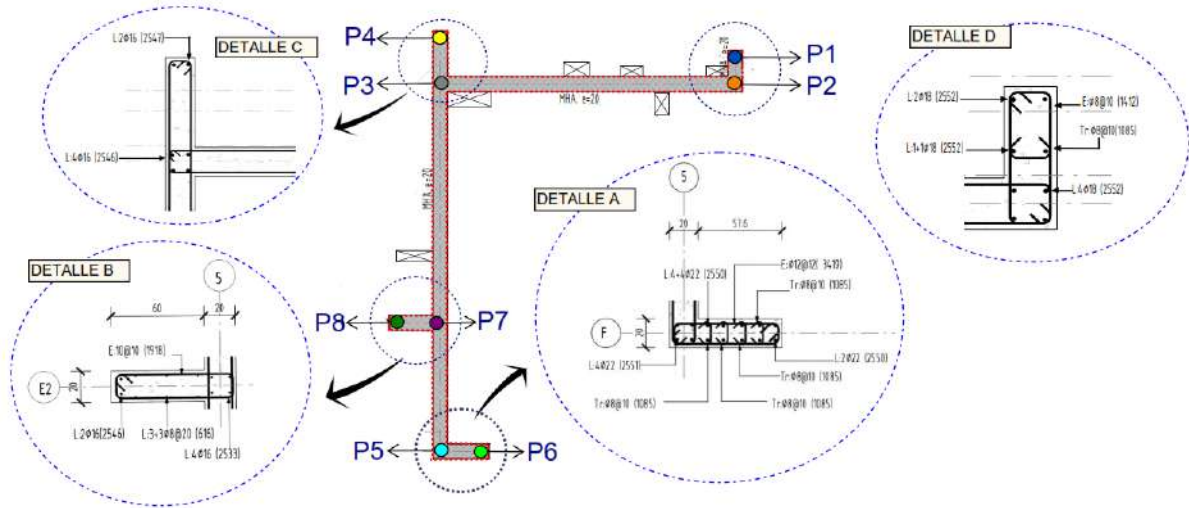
Muro con asimetría seccional compleja desfavorable en Y.
